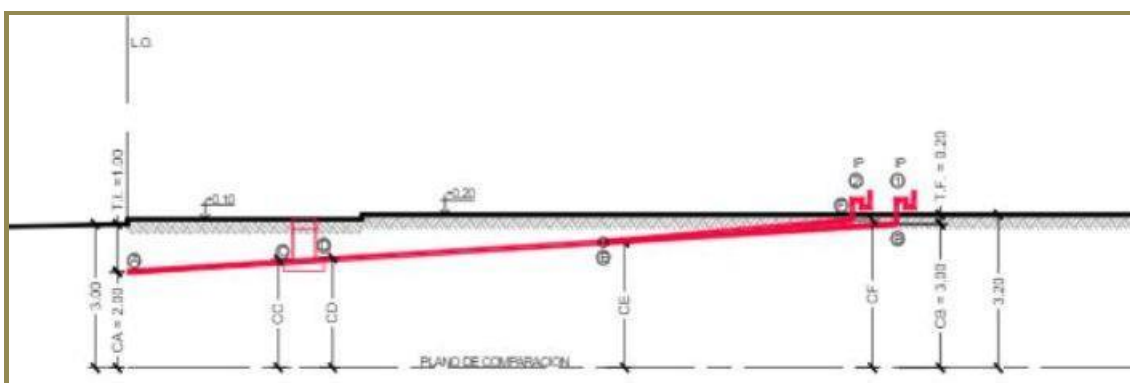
Plano del perfil longitudinal calculado para instalación de la cañería. Fuente Elaboración propia
